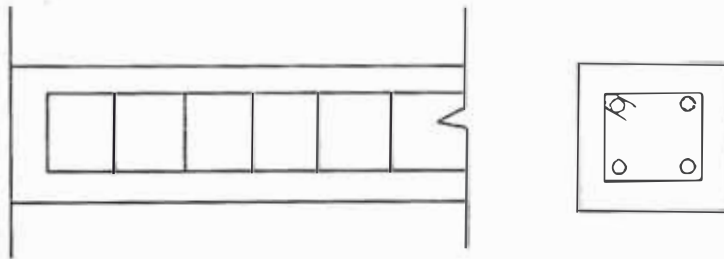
Armadura a esfuerzo cortante con estribos verticales.
